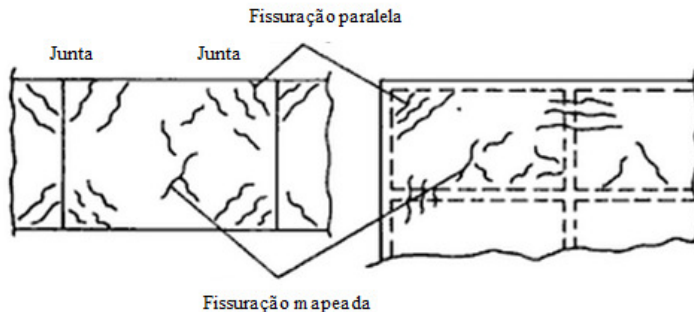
Fissuração plástica na superfície de pavimentos de concreto e de lajes contínuas
